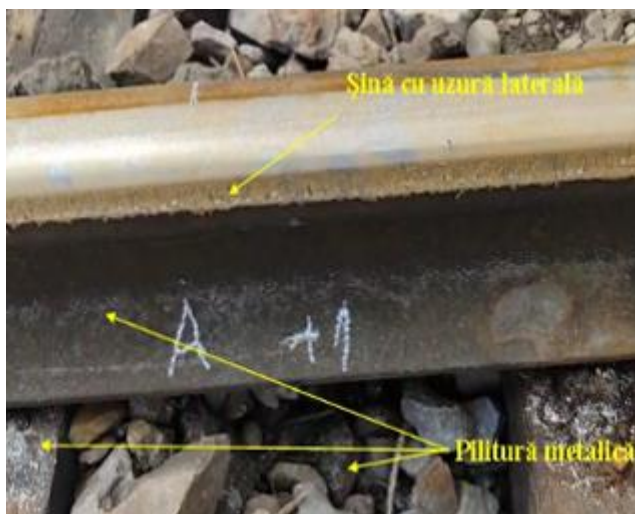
Șină uzată cu pilitură pe talpa șinei
